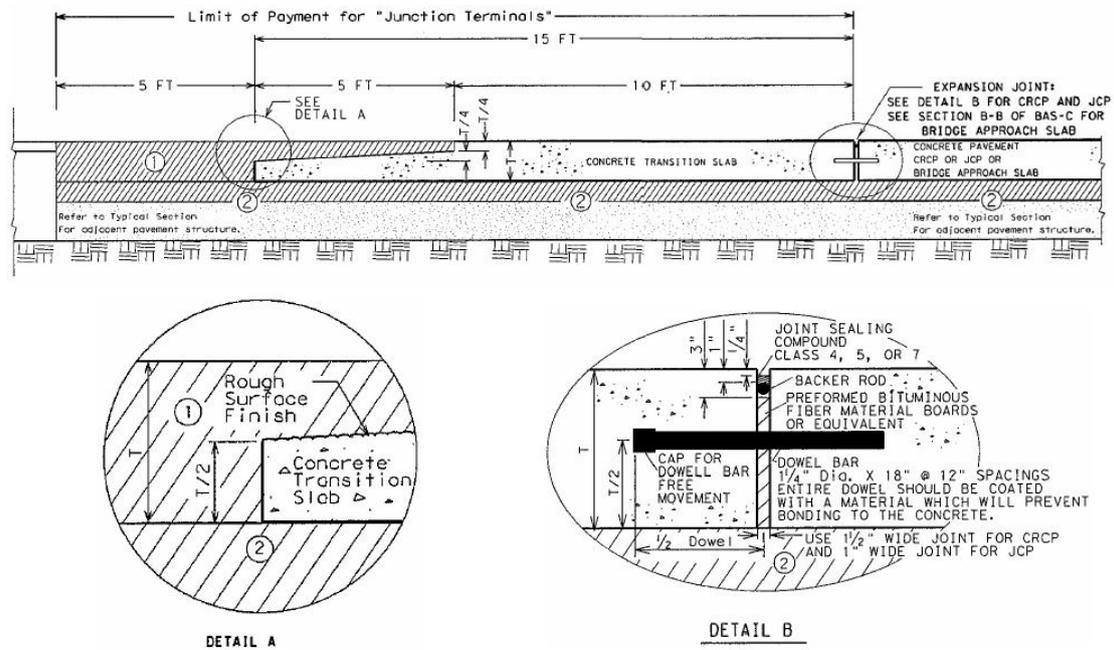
水泥混凝土與瀝青混凝土鋪面銜接之實驗性調整設計(詳細圖)
